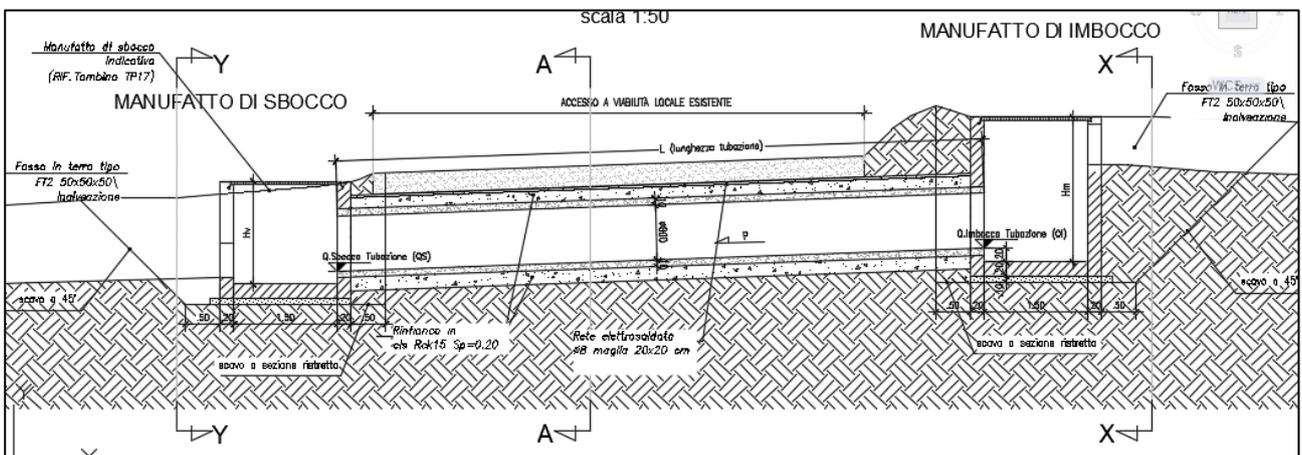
Sezione tipologica attraversamento idraulico – Modifica Tecnica n. 264.
